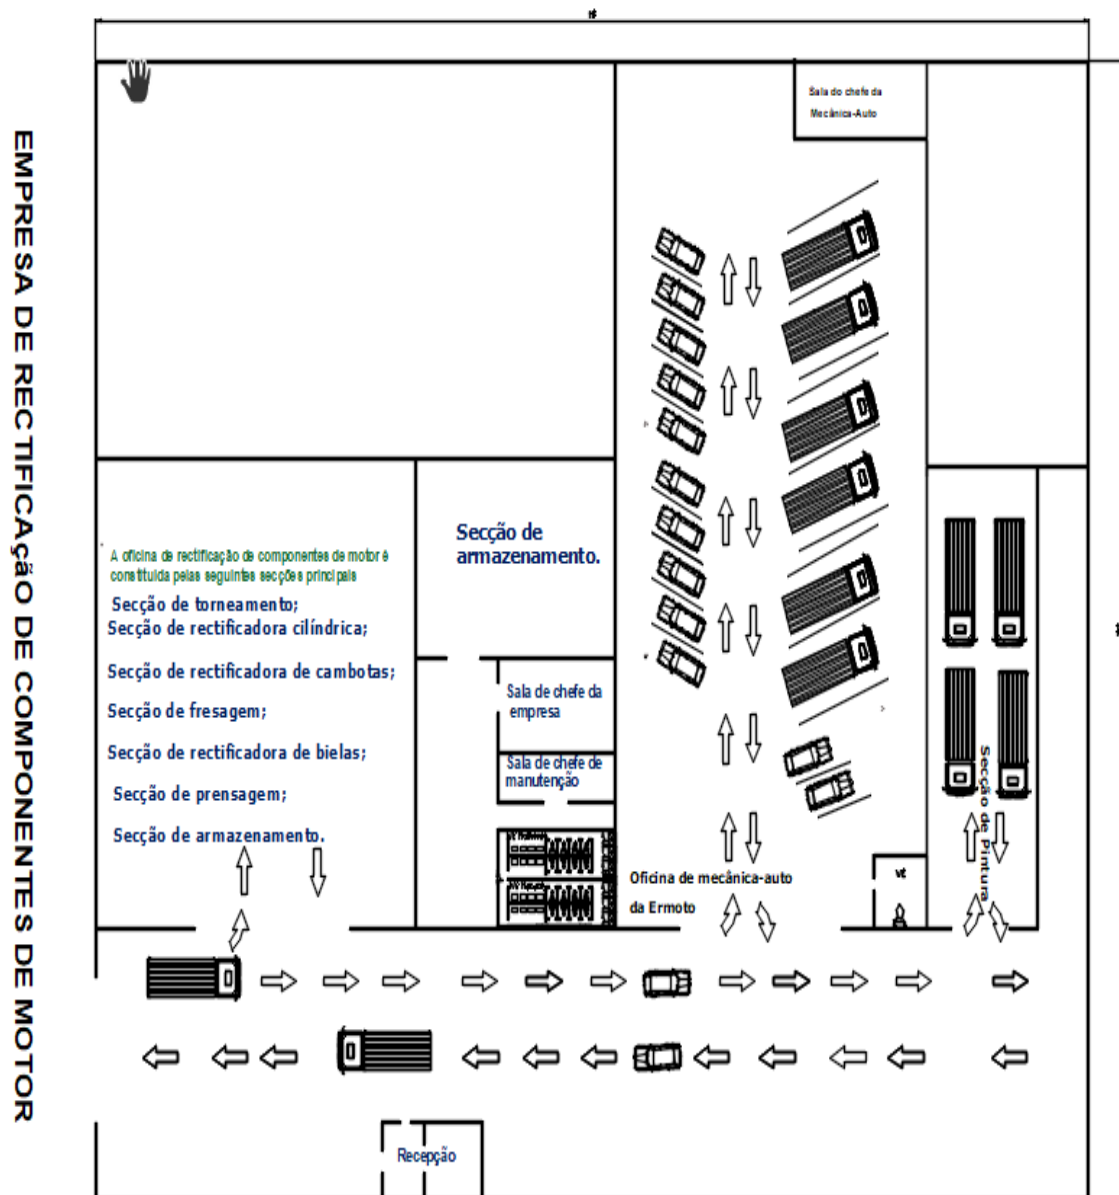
Planta da Ermoto, Lda (fonte: Autor)
